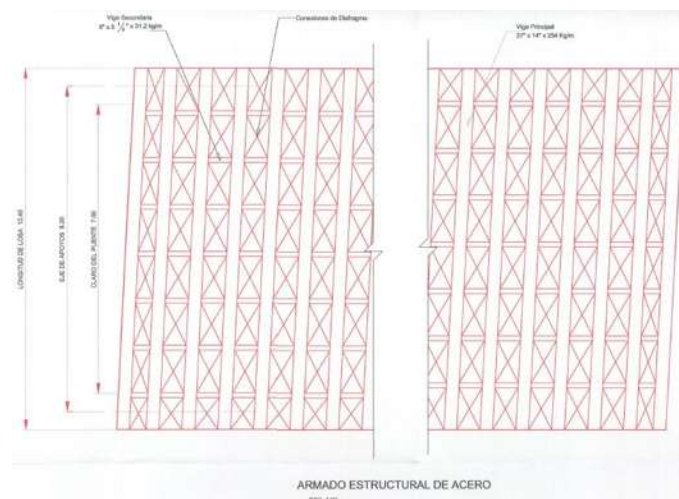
Detalle planta del sistema de piso de la superestructura
